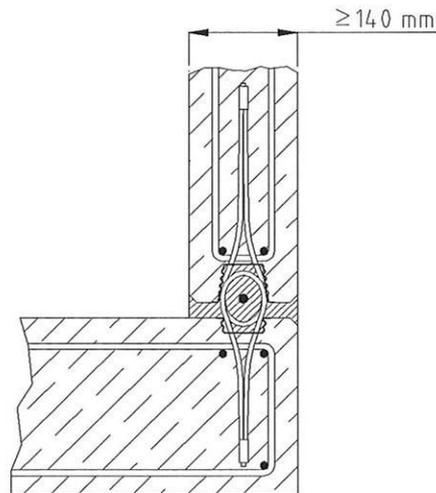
Wand - Wand – Eckverbindung - Regeldetail
